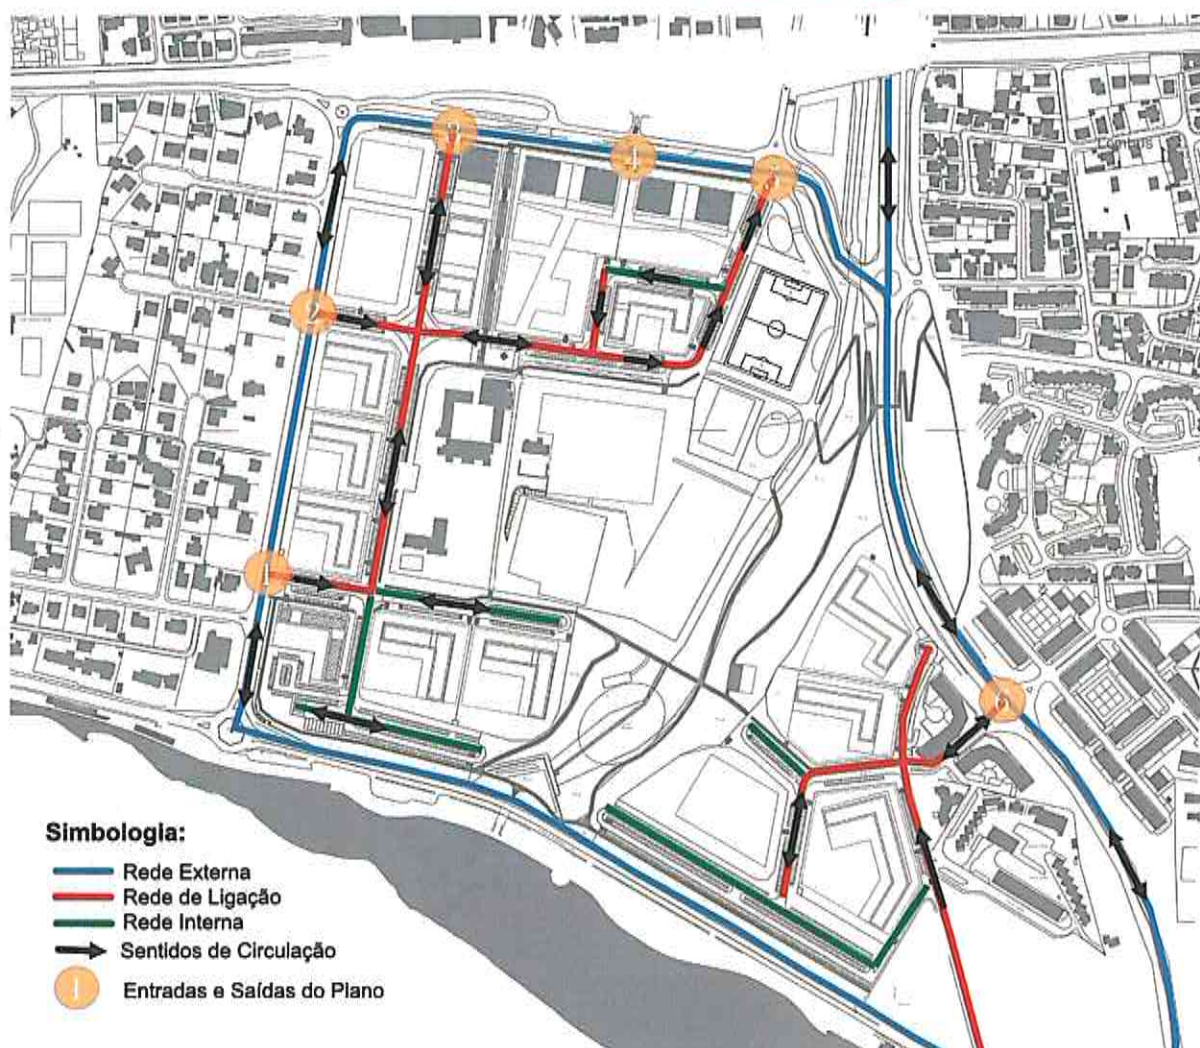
Planta Geral com Atualização do Plano de Pormenor
